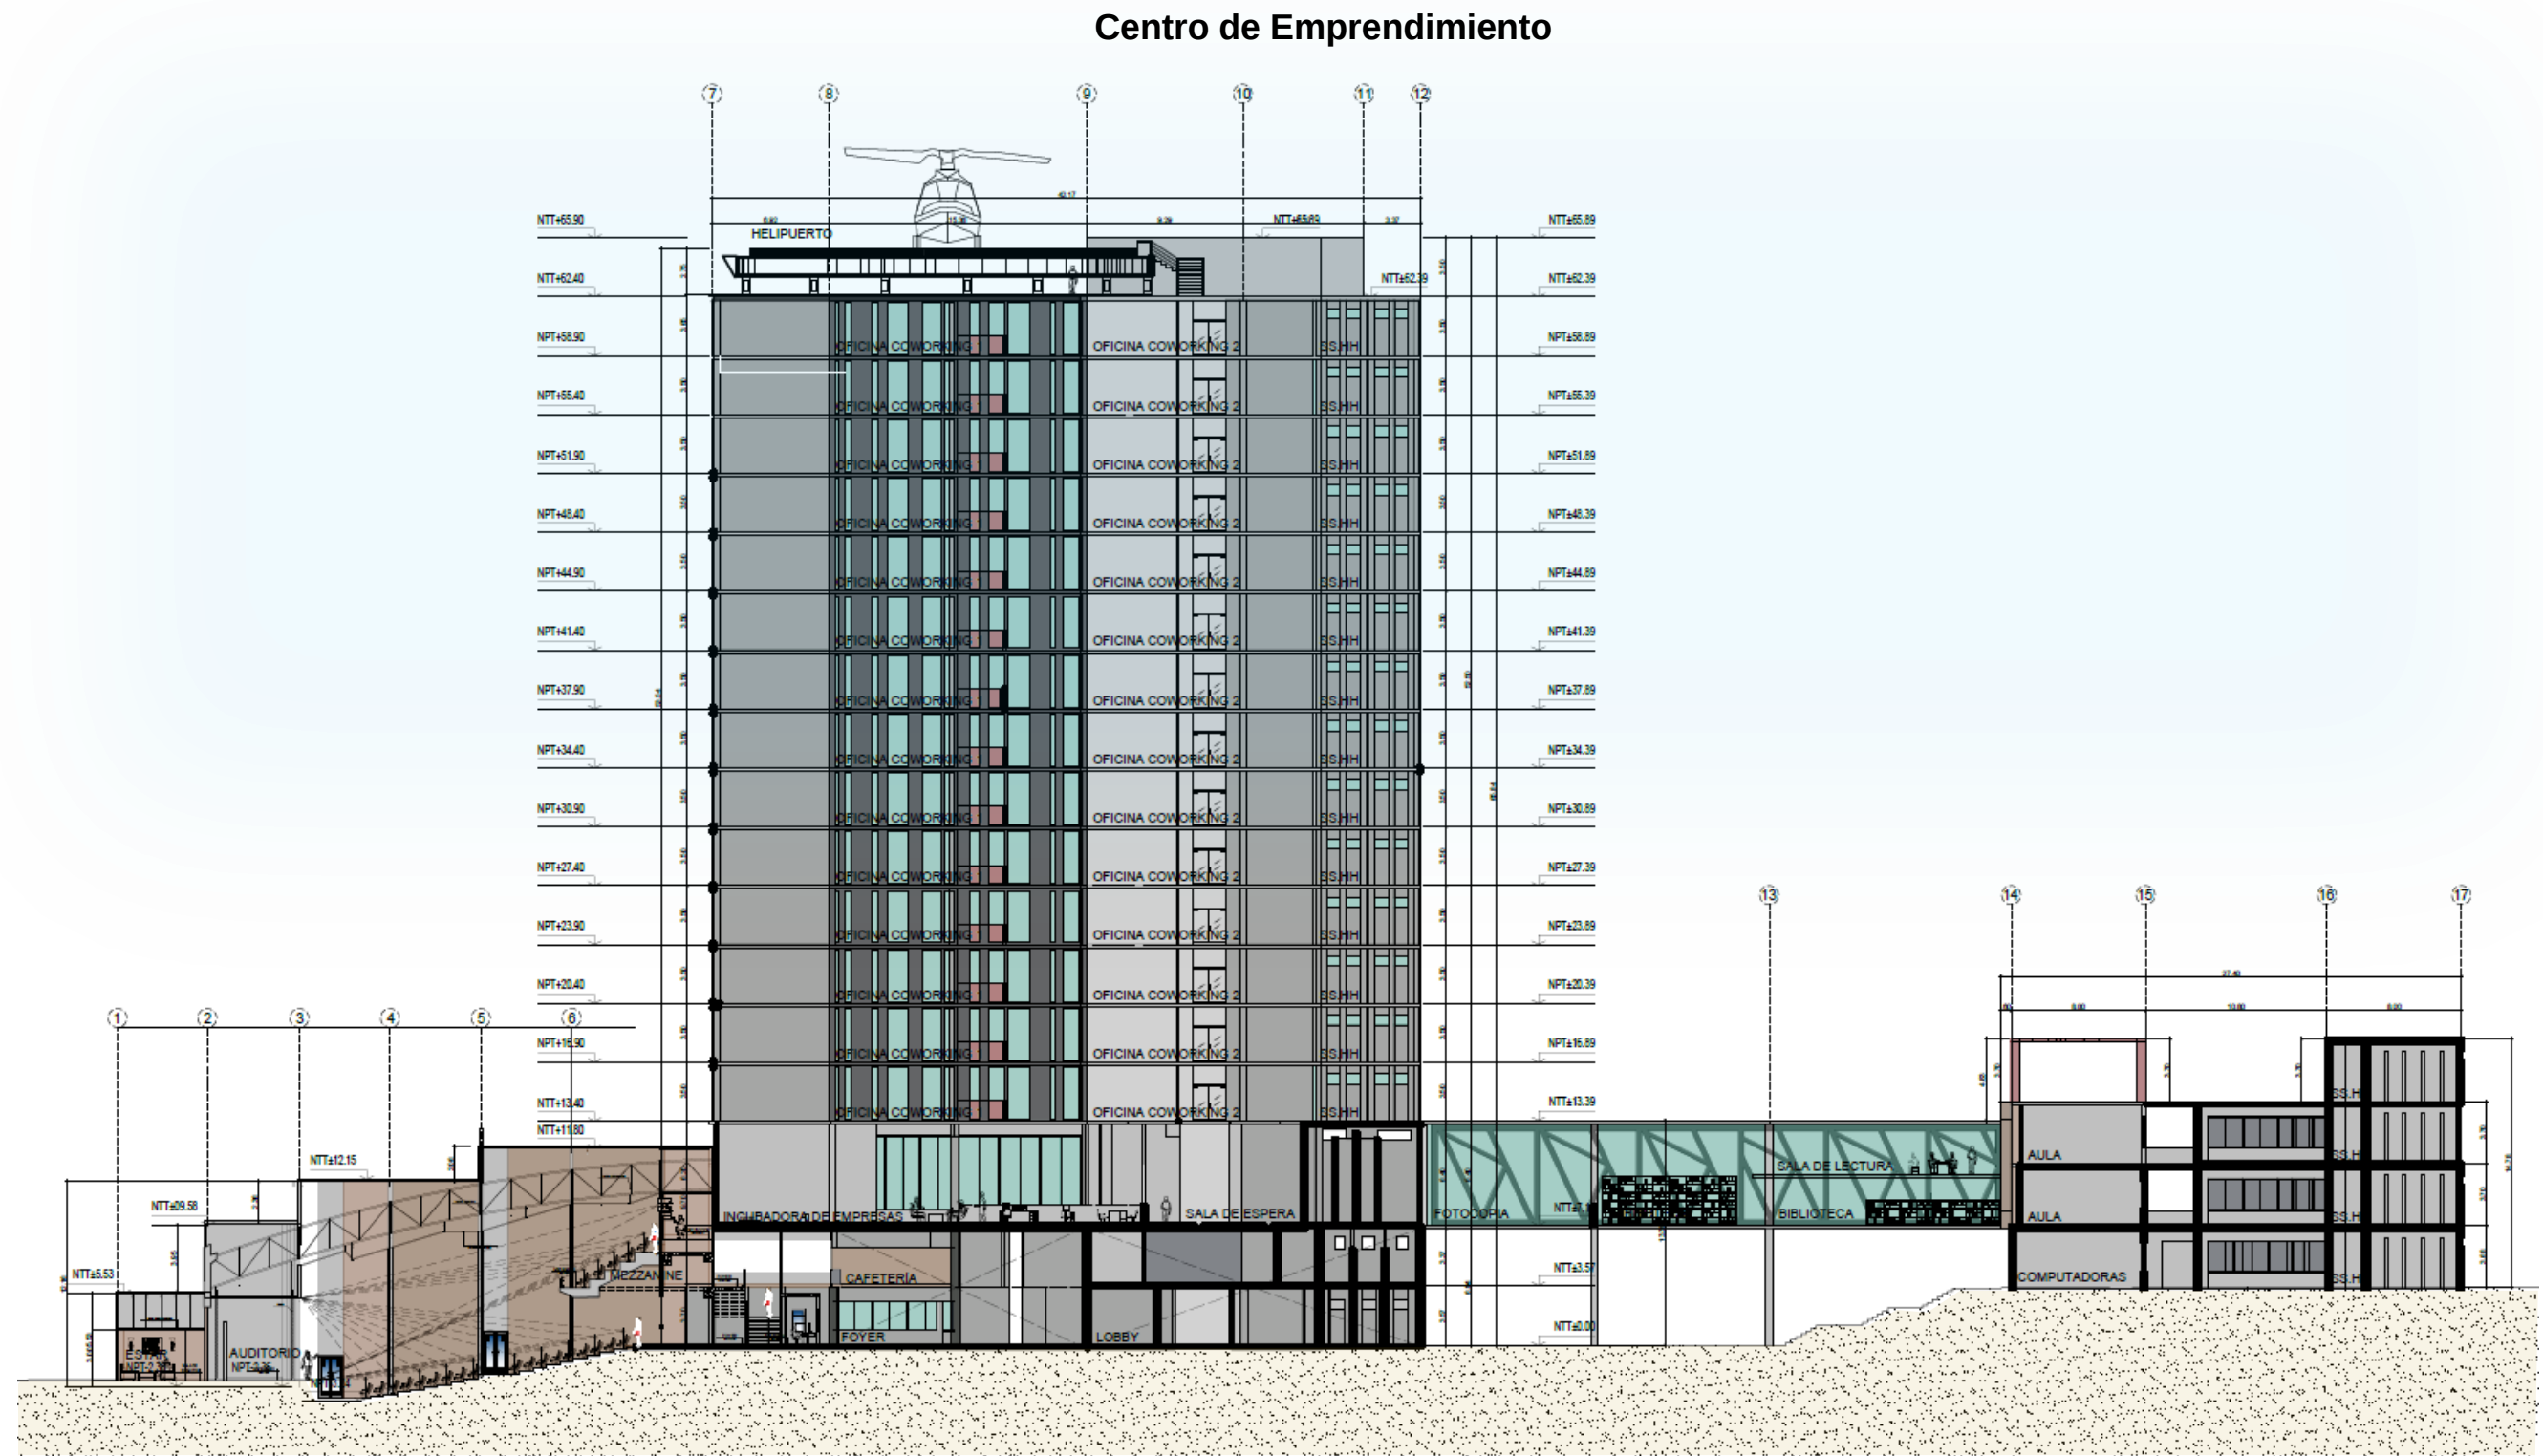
Corte Longitudinal del Proyecto. Elaboración Propia.
